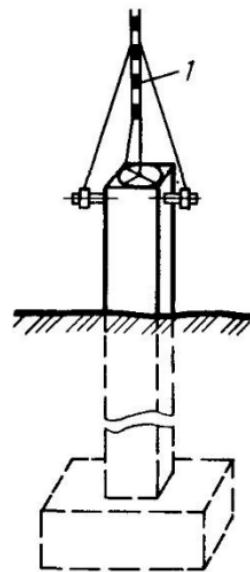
Бетонный столб для закрепления пунктов триангуляции:
